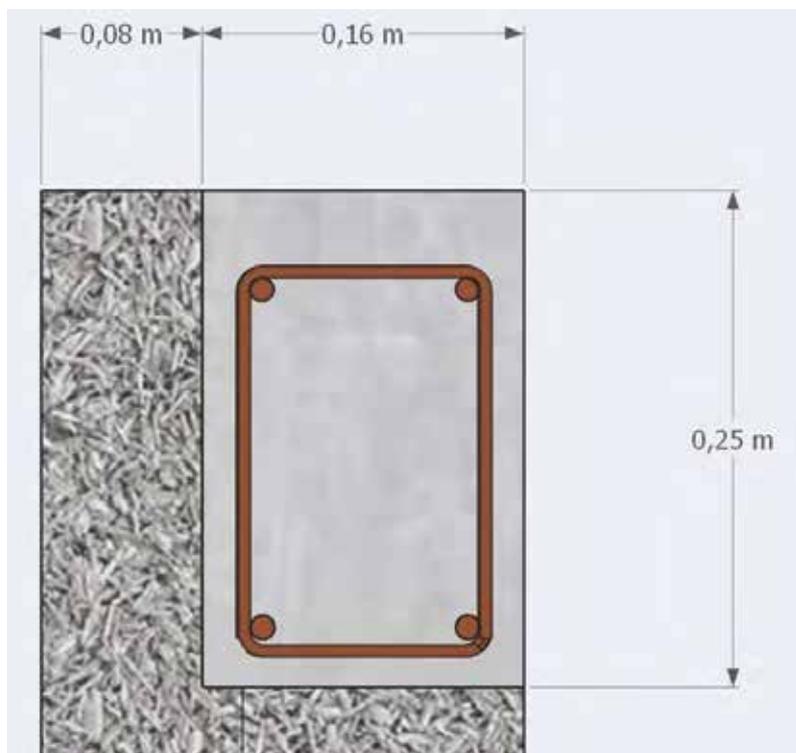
Vue de principe en coupe d'un chaînage vertical Principal
